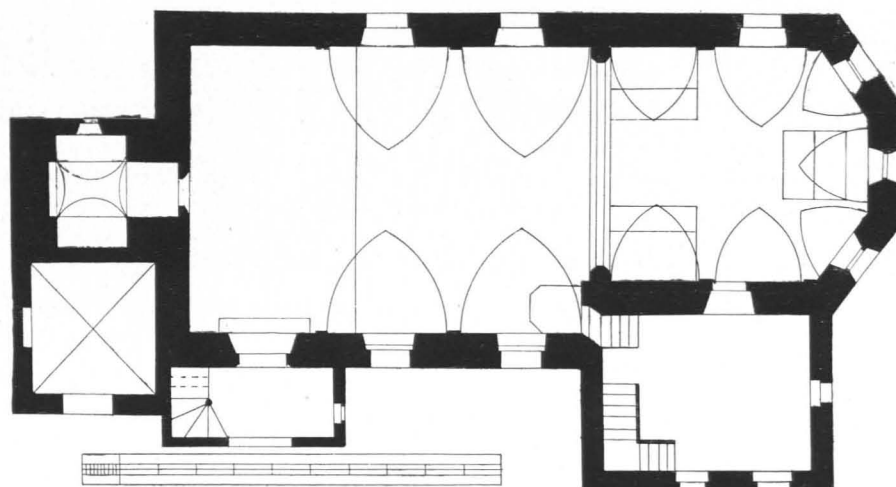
Seeham, Pfarrkirche, Grundriß 1 : 200 (S. 351)
